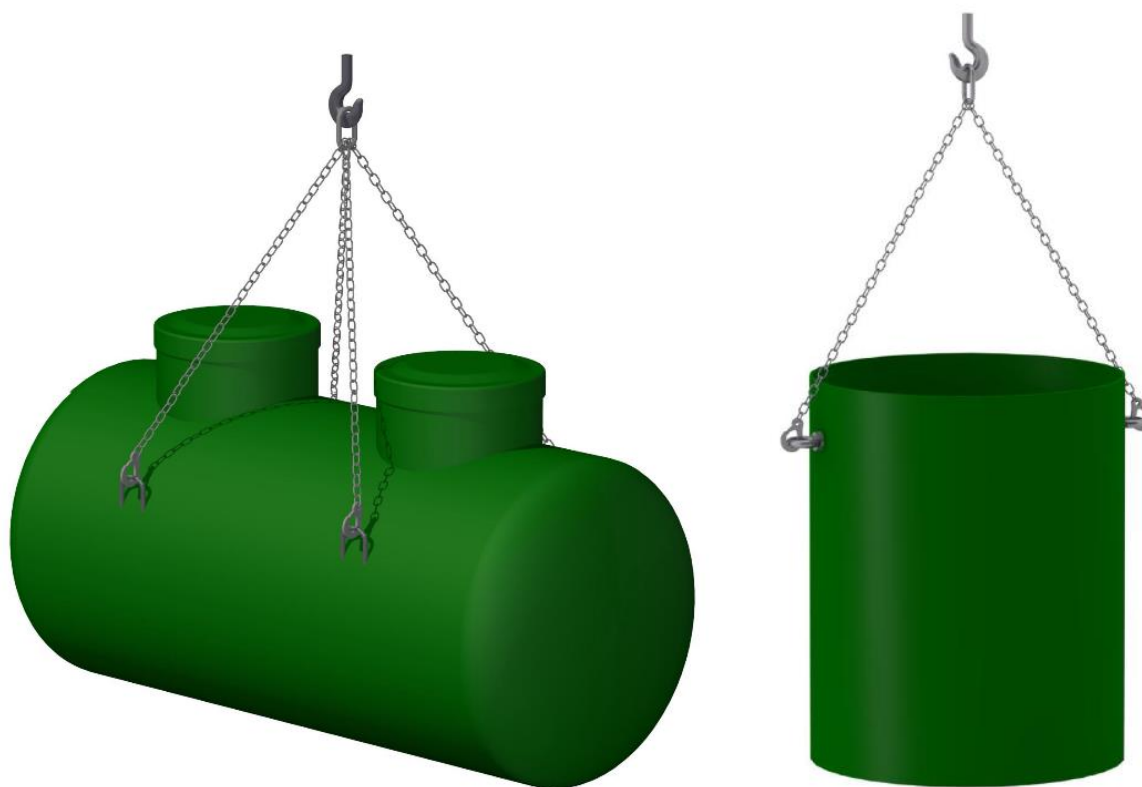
Метод строповки стеклопластиковых корпусов изделий
